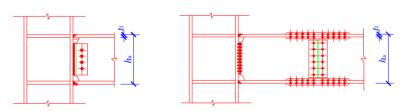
型钢混凝土内型钢梁与柱连接构造
